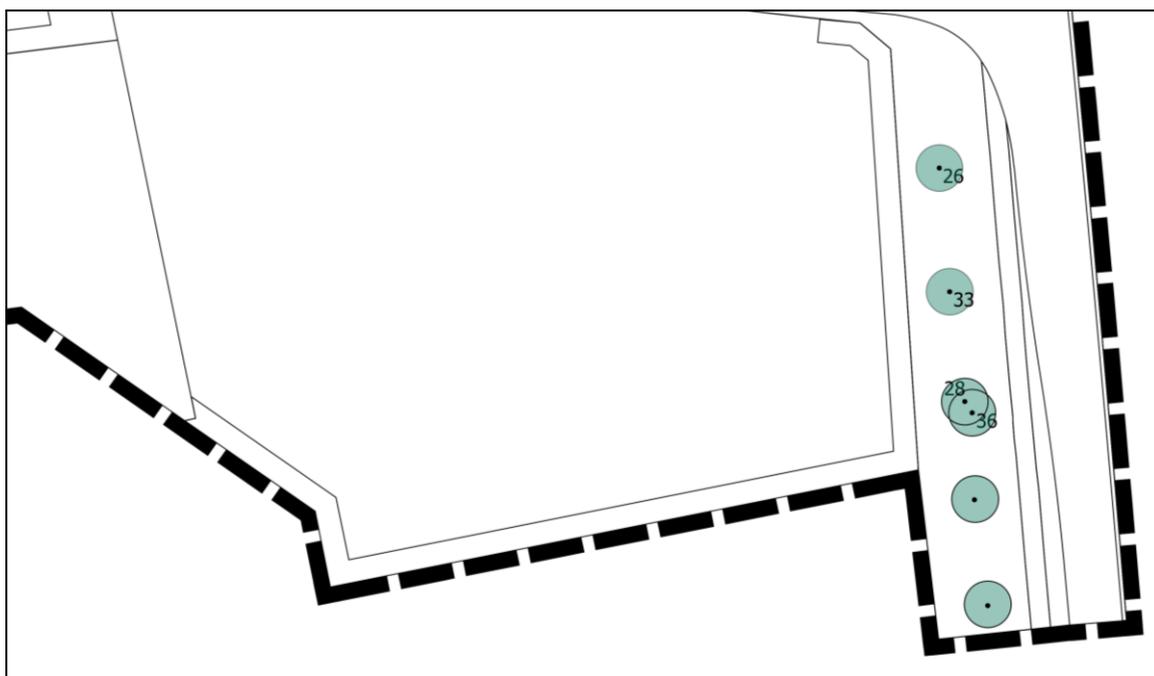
Erhalt Bäume Bereich Heisinger Straße mit Angabe zum Stammdurchmesser (cm)
